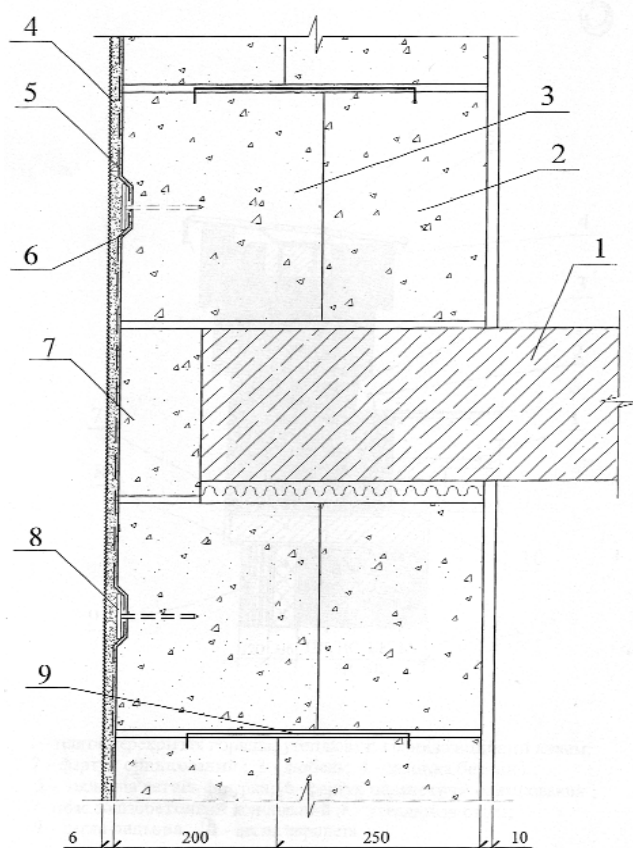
"Укрстіна". Фасадна система "Дюбель":
